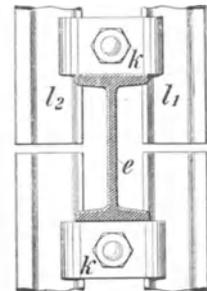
Befestigung der Schachtleitungen bei der Briartschen Führung mit Mitteleinstrich.
